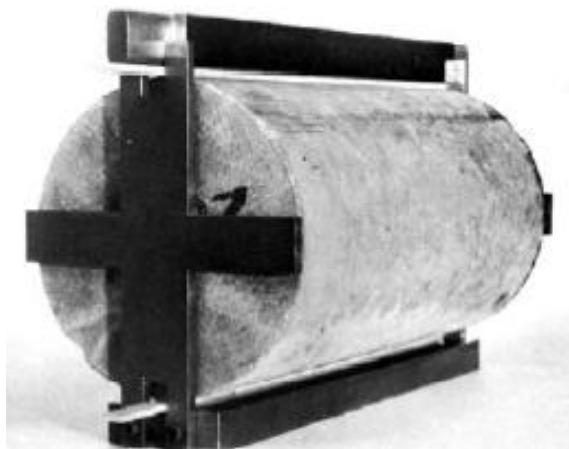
3. Plantilla para alinear el cilindro de concreto y los listones de apoyo
